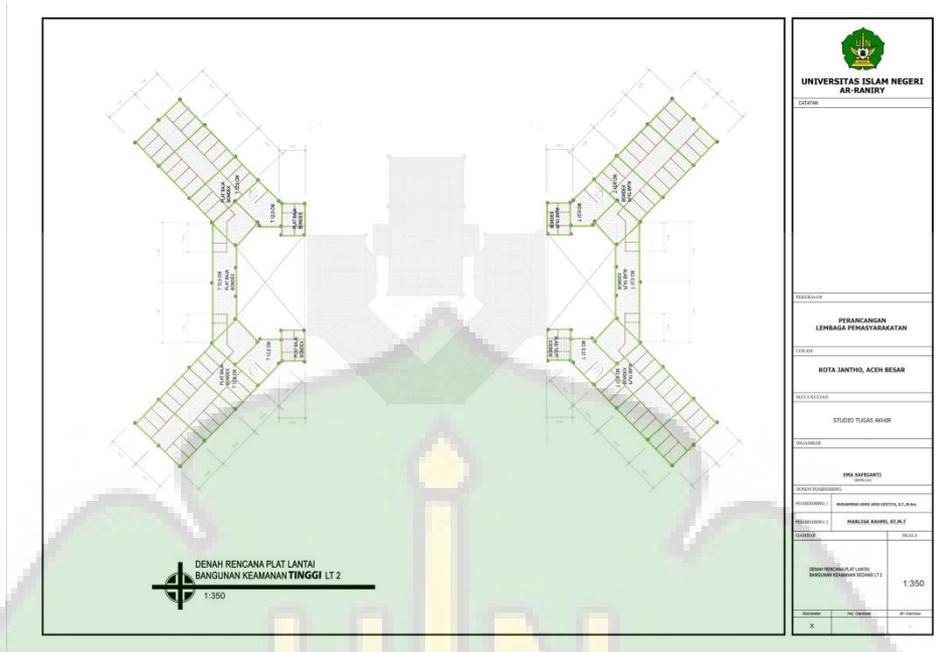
Denah Lt 2-5 Bangunan Keamanan Tinggi
